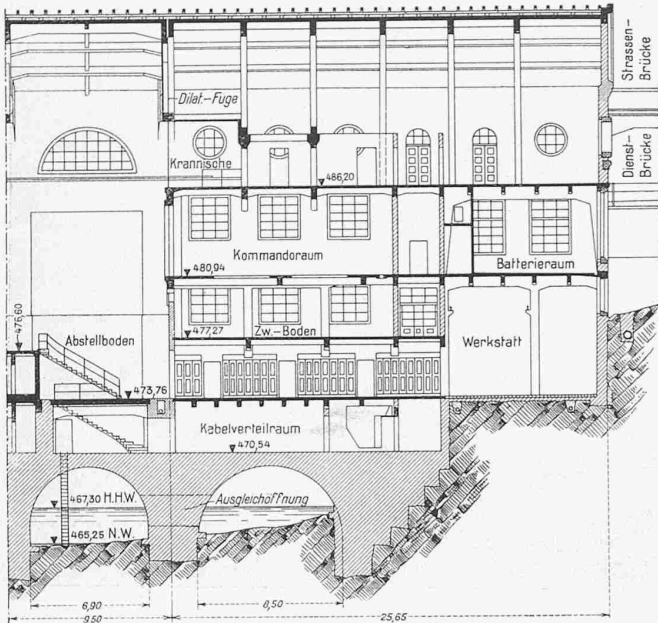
Längsschnitt durch den Maschinenhausbau. — 1:400.
